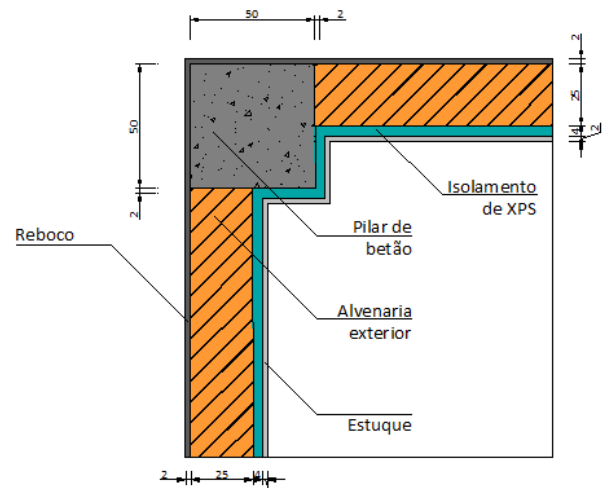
Pormenor construtivo com isolamento pelo interior do edifício II.
